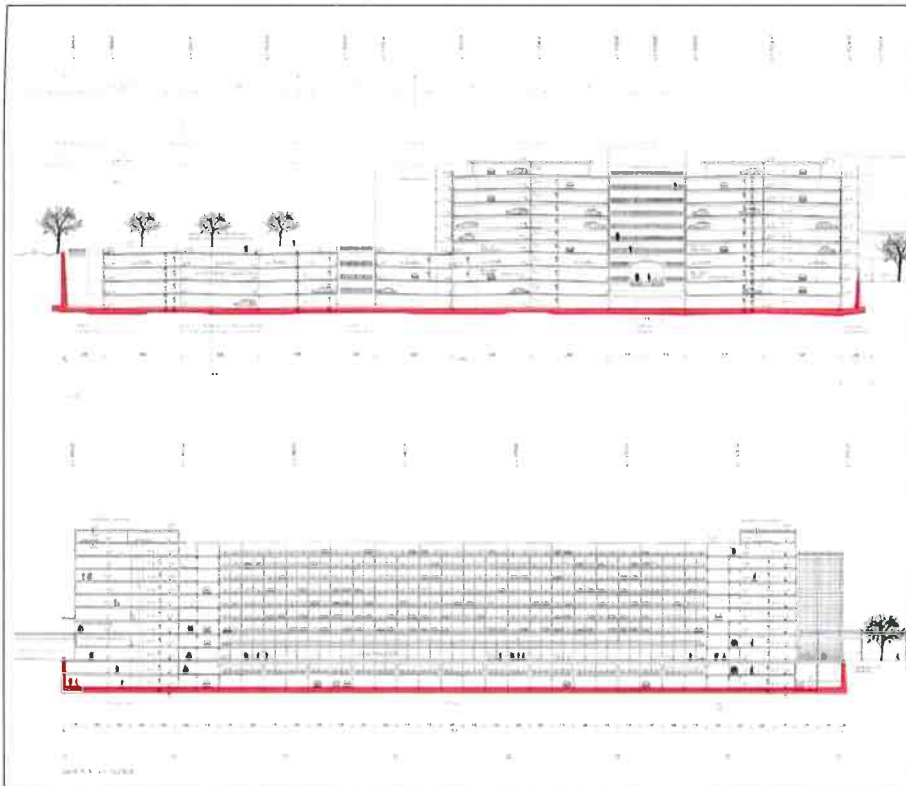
Schnitte durch das Parkhaus mit Darstellung der WU-Konstruktion (rot eingefärbt)
